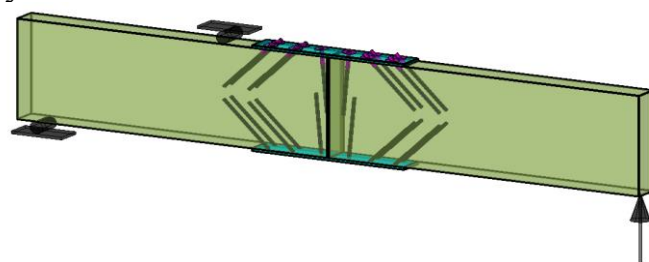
Схема нагельного соединения и расчетная схема балки на трехточечный изгиб
